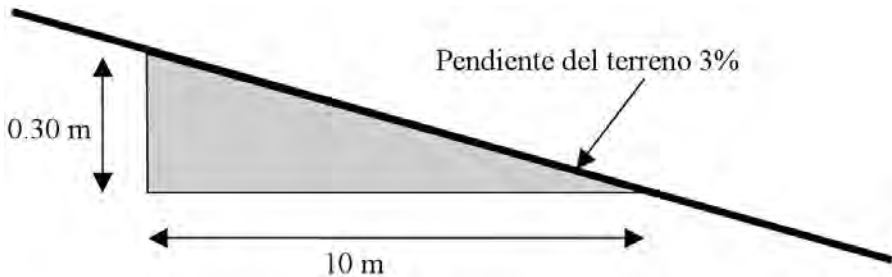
Perfil transversal de la excavación para el vertedero de máximas.
